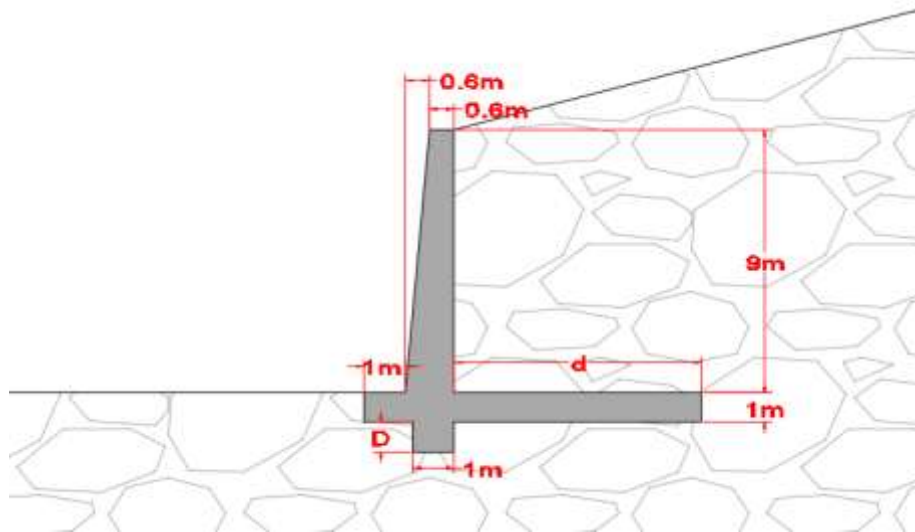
PRE DIMENSIONAMIENTO MURO CANTILÉVER
